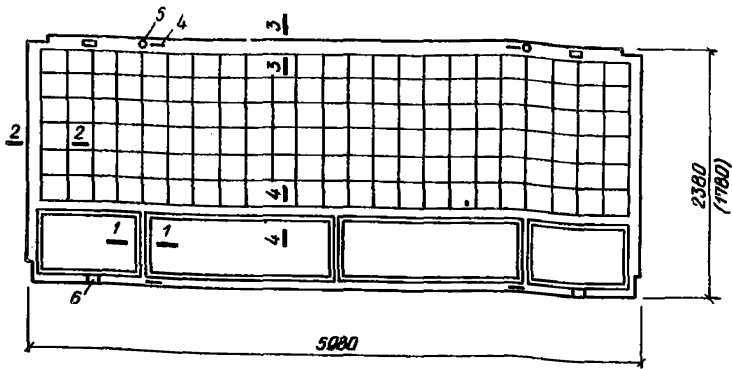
Стекложелезобетонная вертикальная навесная панель из стеклоблоков БК 244/98 с утолщенной обвязкой и проемами для установки створного остекления
